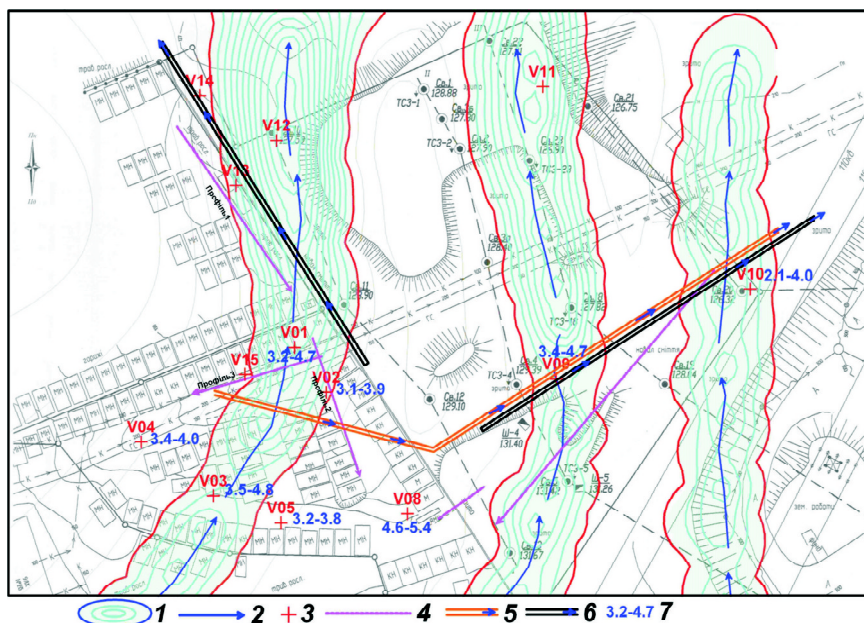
Возможные варианты строительства дренажа для отвода грунтовых вод в районе строительной площадки: 1 – зоны увлажнения грунтов; 2 – направление миграции грунтовых вод; 3 – пункт ВЭРЗ; 4 – профили георадарного зондирования; 5 – вариант дренажной системы 1; 6 – вариант дренажной системы 2; 7 – глубины кровли и подошвы первого водоносного горизонта, м
